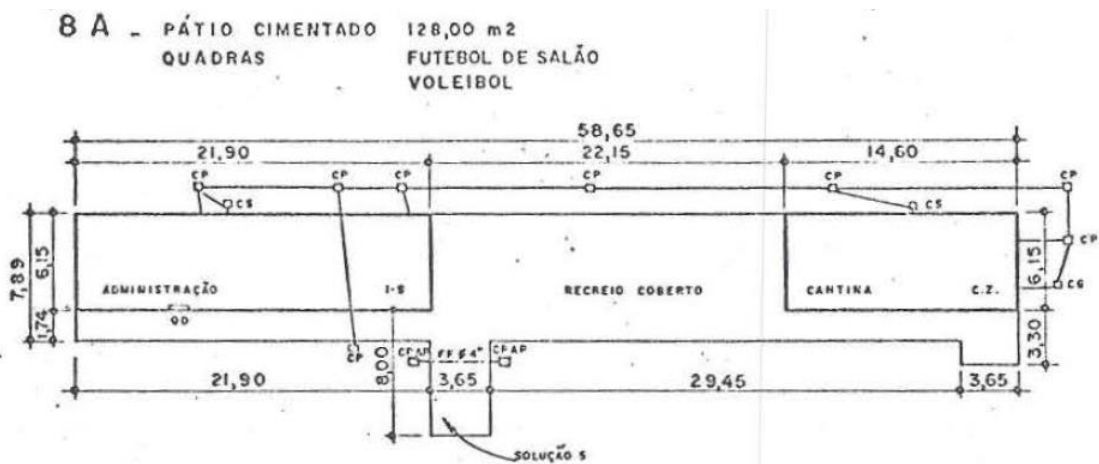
Padrão 4 - 8A – Gabarito do 1º pavimento - 8 salas em 1 bloco (FONTE: CARPE:197-)
